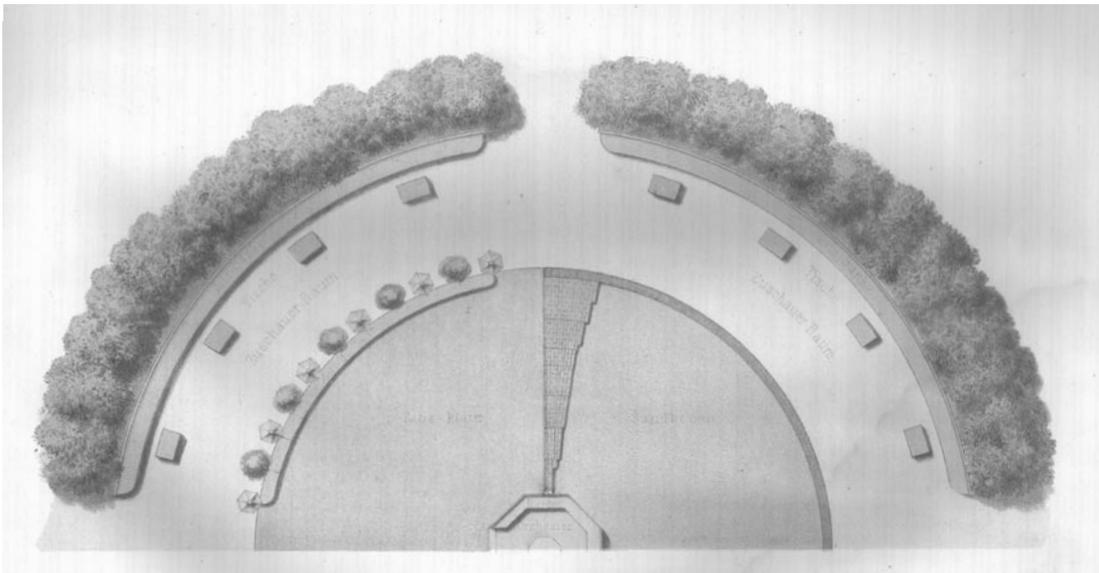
(oben) und 84 (unten): Tanzplatz nach Becker 1868, oben Ansicht und Aufbaudetails , unten Grundriß teilweise mit sichtbarem Schichtaufbau
